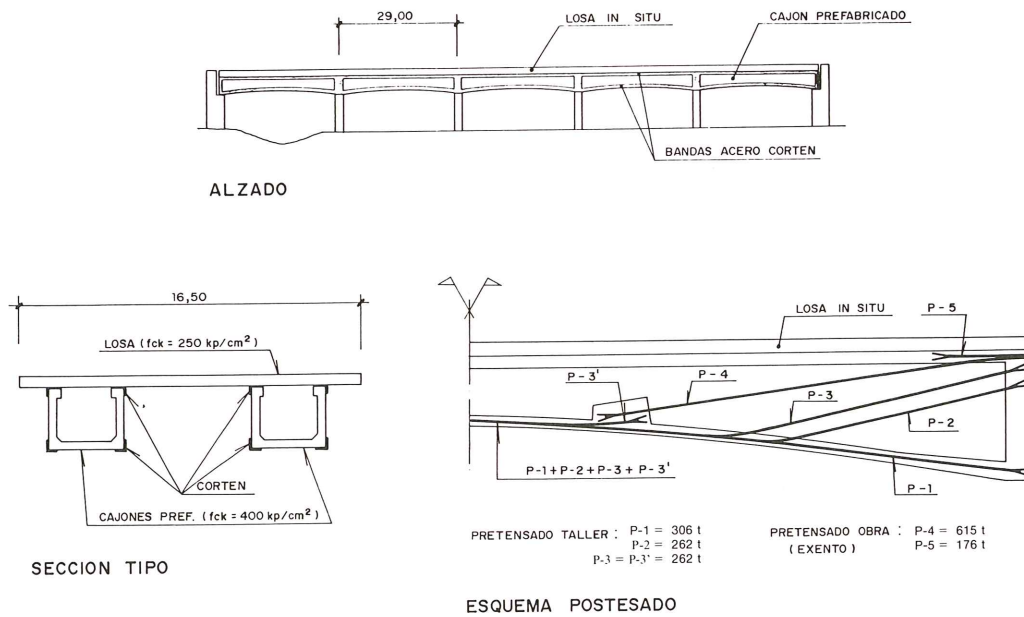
Puente continuo en hormigón prefabricado, con postesado exento.
